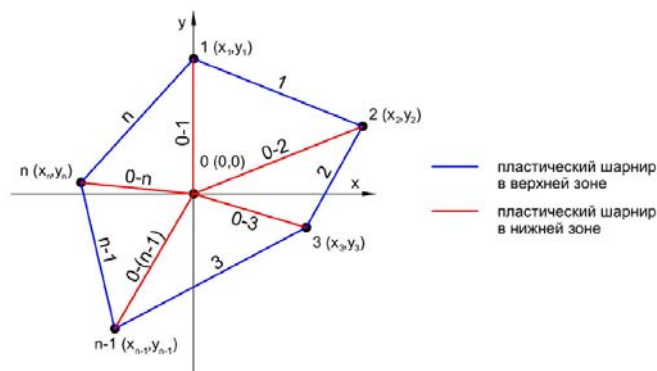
Схема излома перекрытия при удалении средней колонны:
